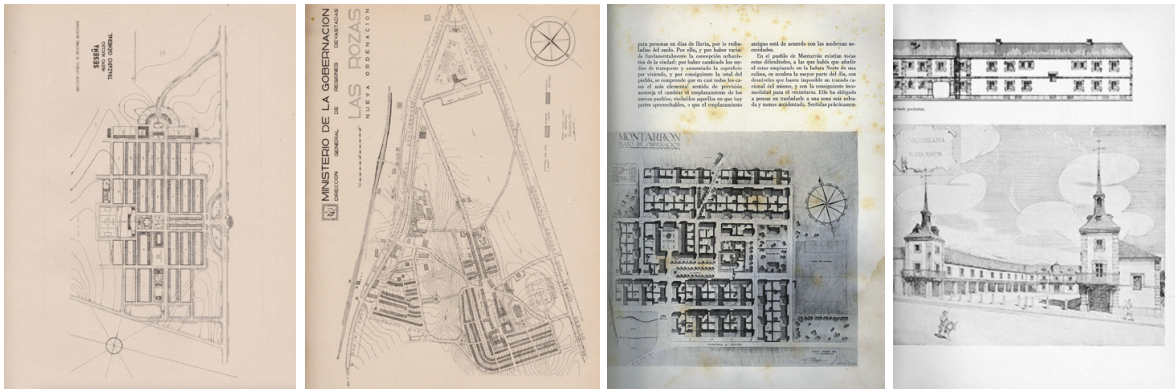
Revista *Reconstrucción*. Izquierda, Plano de Ordenación de Seseña (1941); centro izquierda, Plano de Ordenación de Las Rozas (1941); centro derecha, Plano de ordenación de Montarrón (1941); derecha, Perspectiva plaza mayor de Guadarrama (1942).
